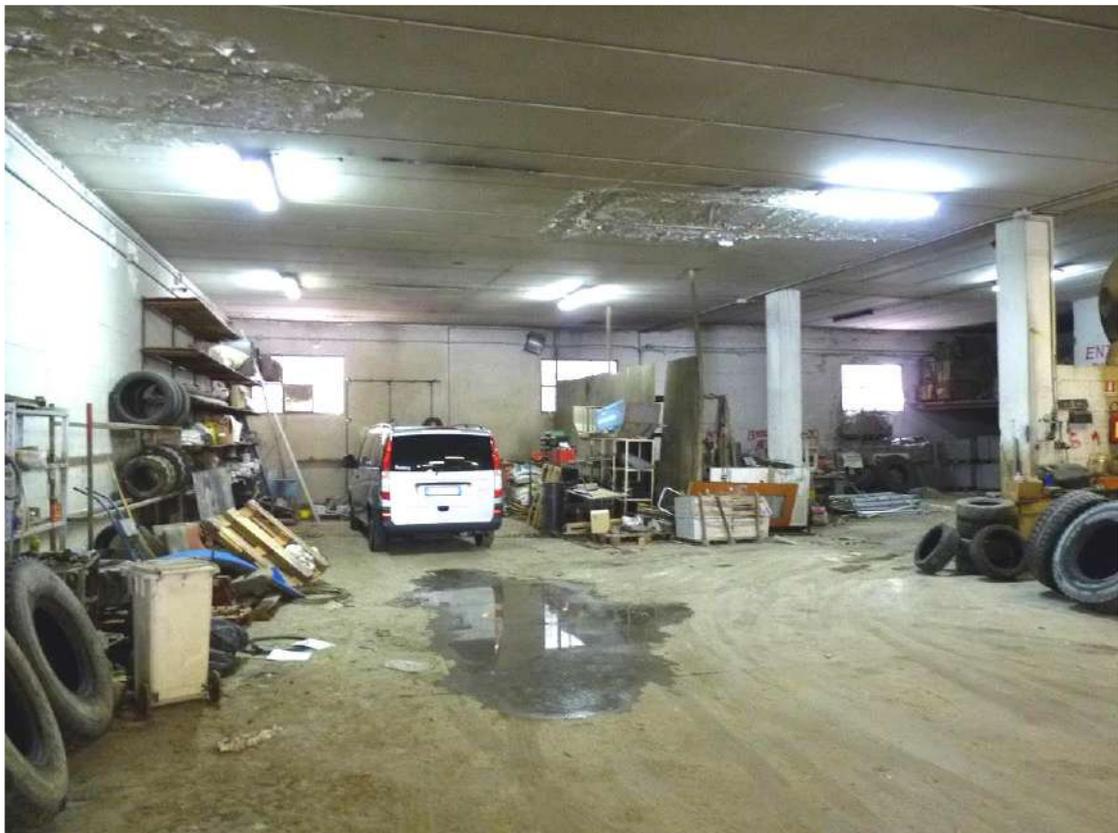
Locale magazzino (sub.25) (porzione opposta a zona di ingresso)
